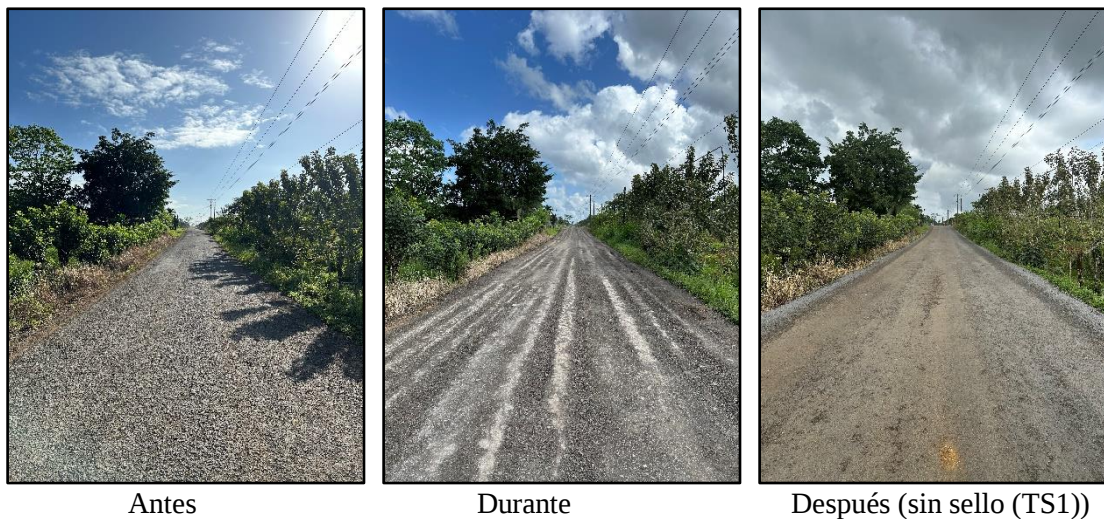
, 37, 38. Etapas constructivas antes durante y después de la colocación de RAP.
